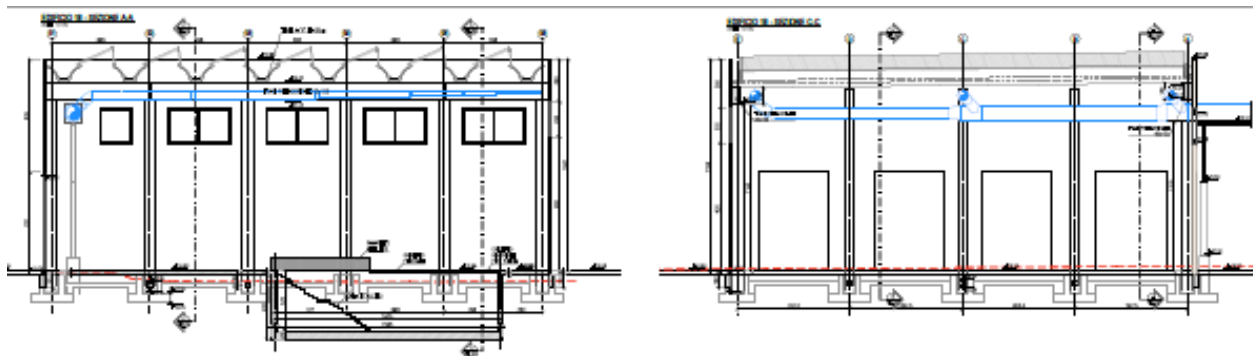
Carpenterie delle fondazioni edifici 18-23-28
